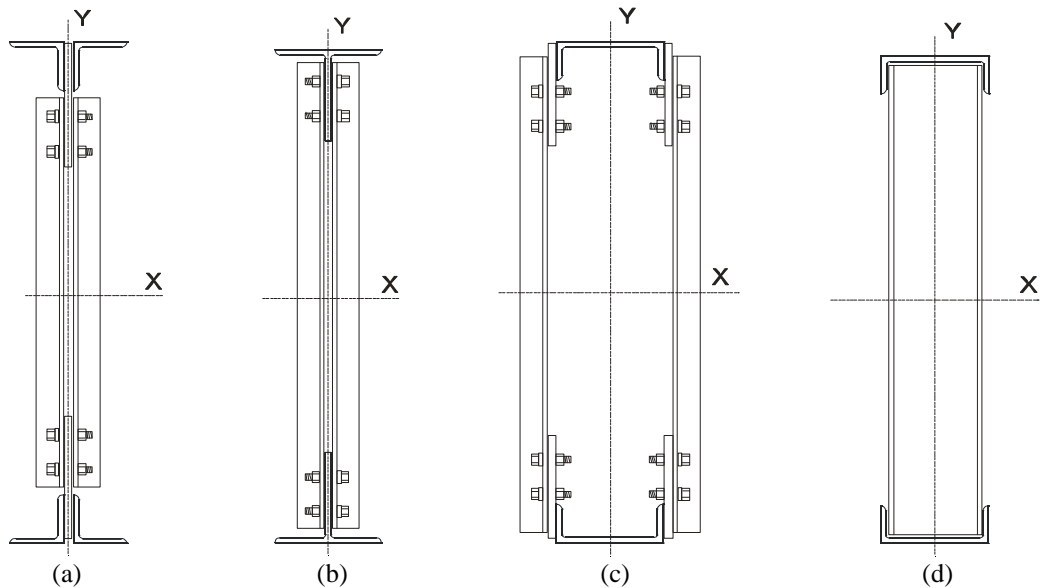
Possibilidades de seções transversais de vigas treliçadas.
